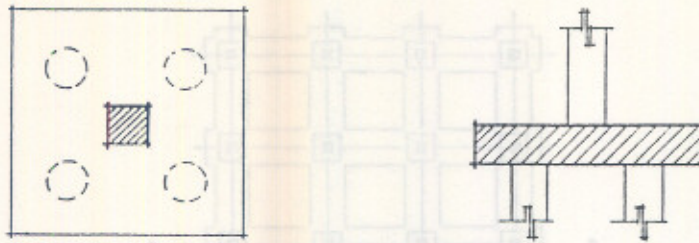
Cimentación de zapatas aisladas con pilotes
